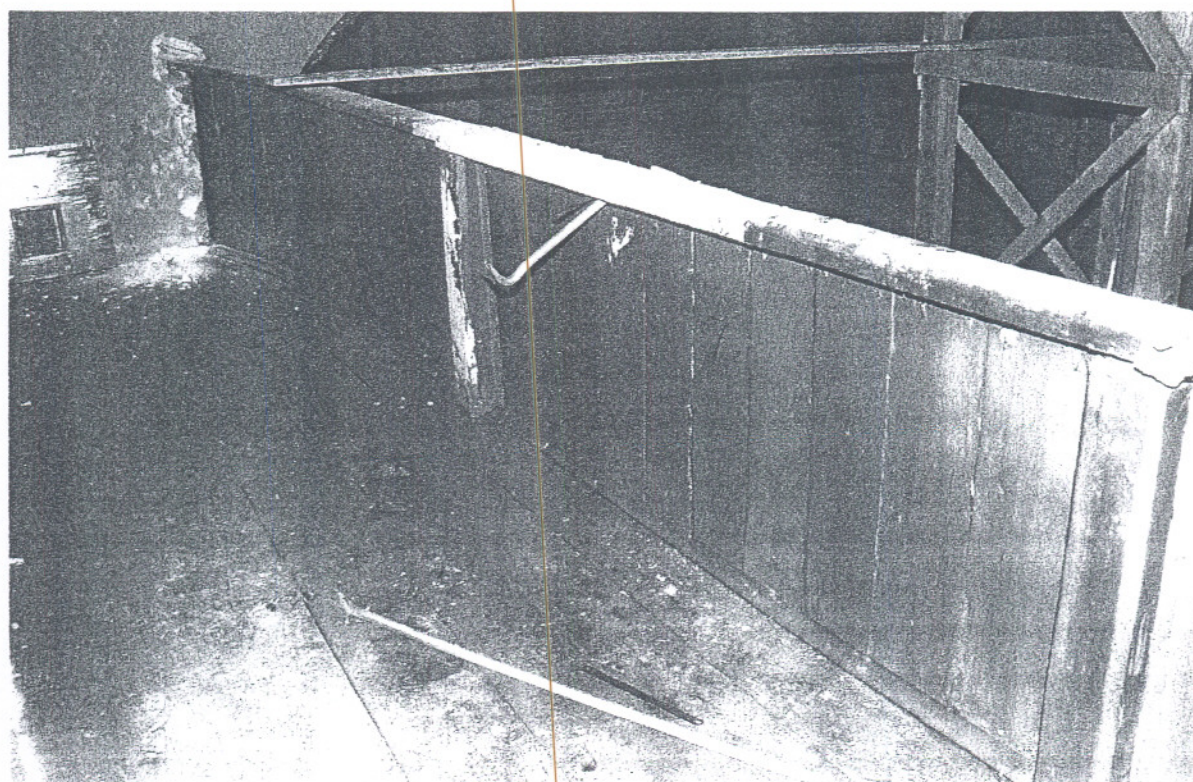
Teatr Stary w Lublinie, ul. Jezuicka18, drewniane loże, stan zachowania przed rozpoczęciem prac rozbiórkowych. II kondygnacja łóż - balkony.
